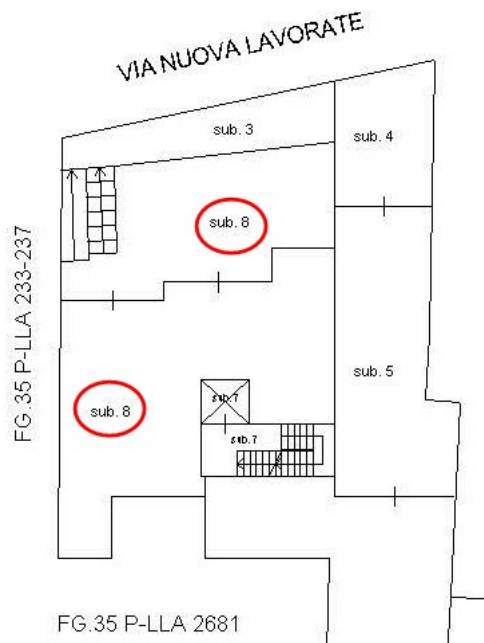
Elaborato planimetrico Piano Terra Particella 2671
